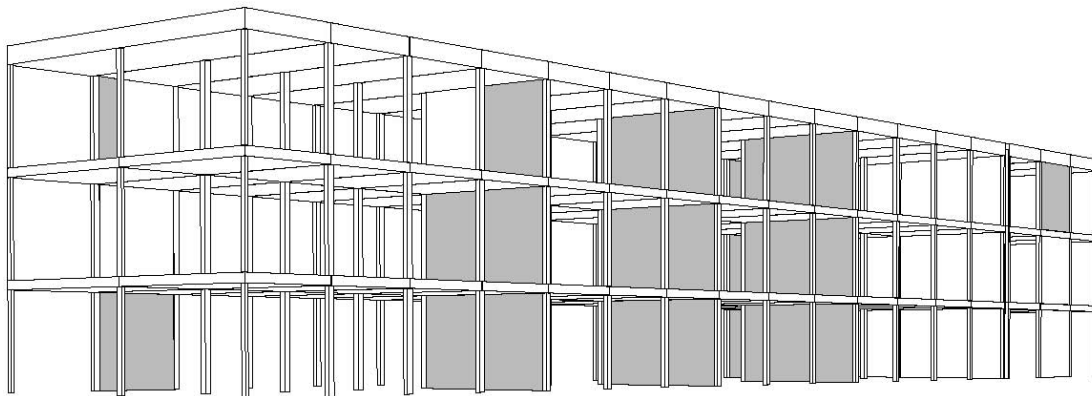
Perspektive Konstruktionsschema, Projekt "Ölzbündt"
